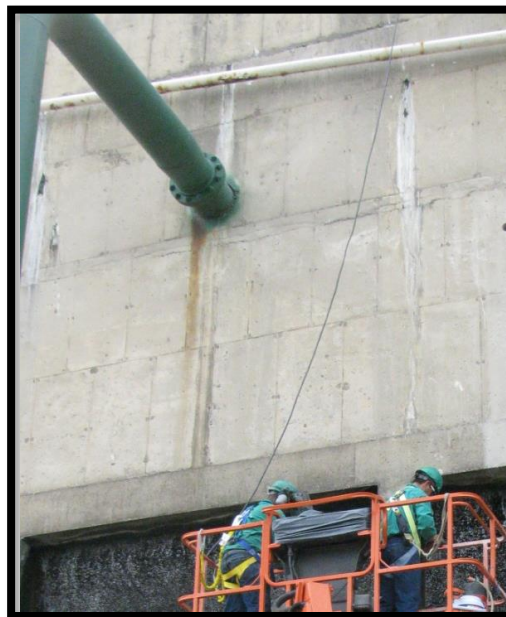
Fotografía detalle fisuración del muro del costado oriental (Fuente: el autor).
